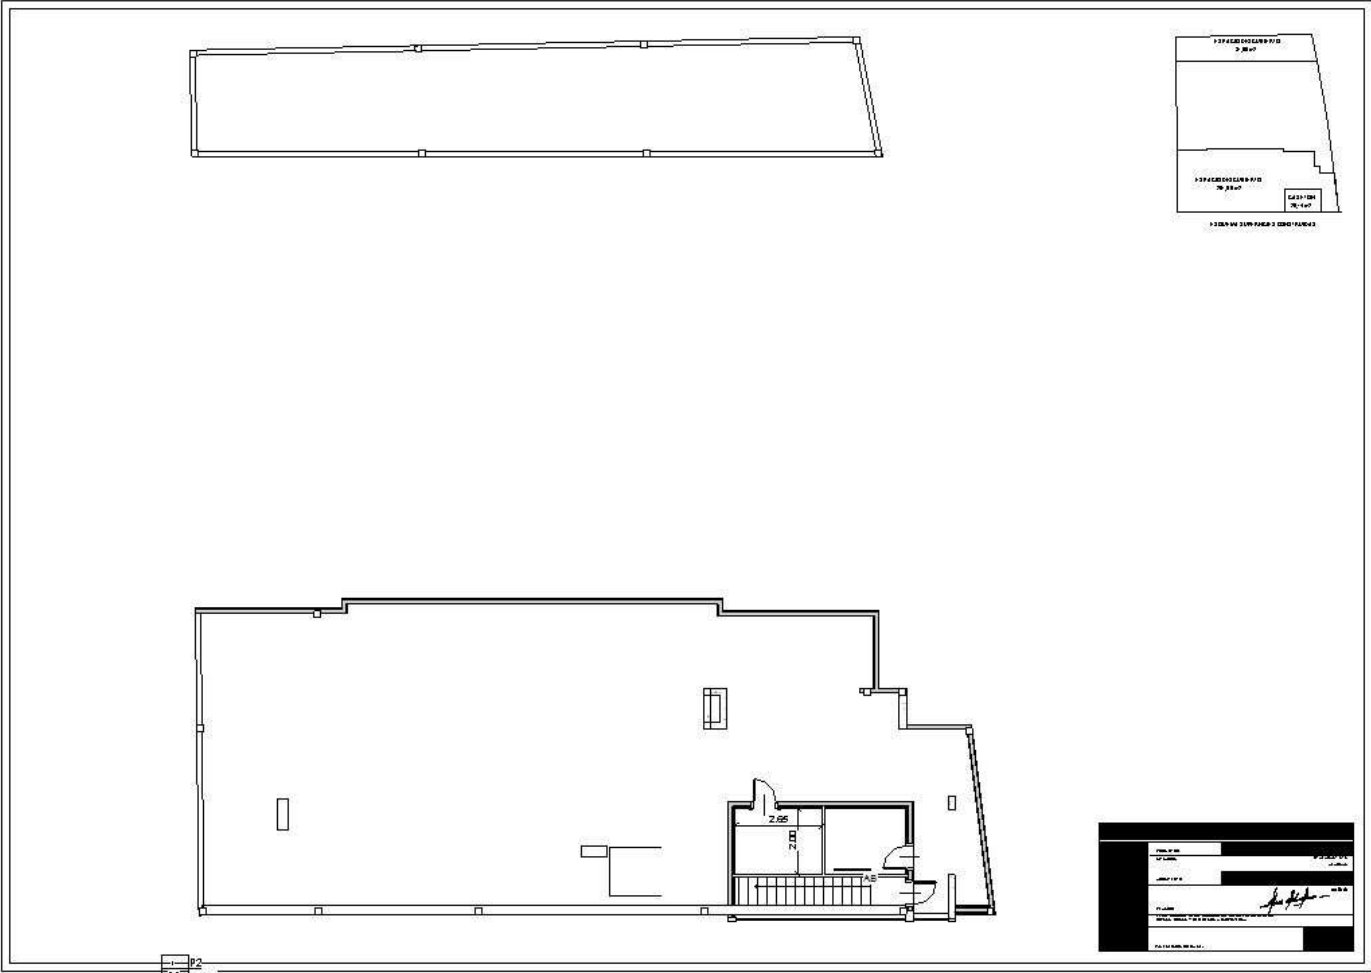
Plano Arquitectónico A-4. Planta Segundo. Fuente propia. 2016
